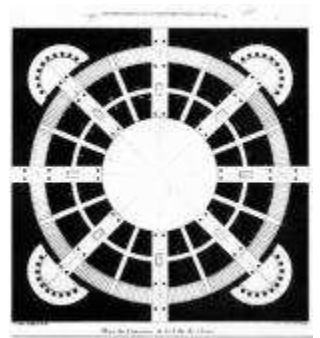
Plan du cimetière de la ville de Chaux – C.N. Ledoux architecte.
